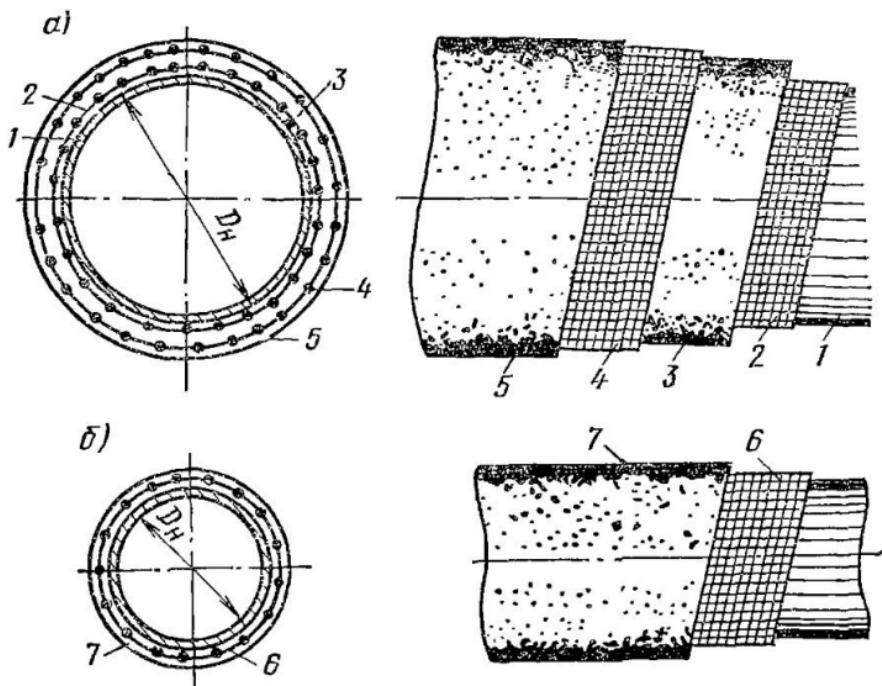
Сплошное монолитное бетонное армированное покрытие подводных трубопроводов
